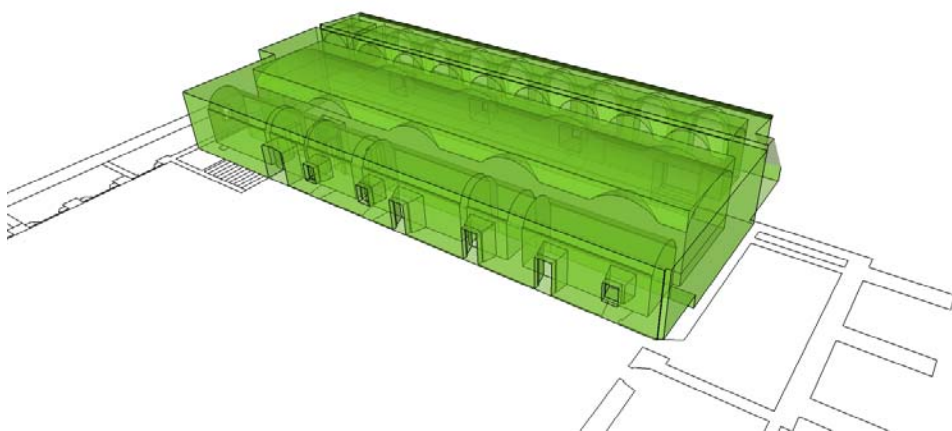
Reconstrucción Virtual Sector 3 a: Ala Norte Planta Baja. Vista desde el Patio
